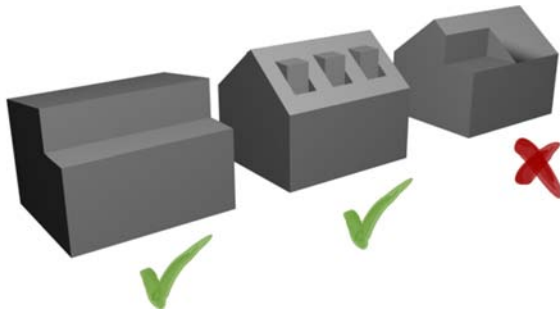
Beispiele für unzulässige Dachaufbauten
